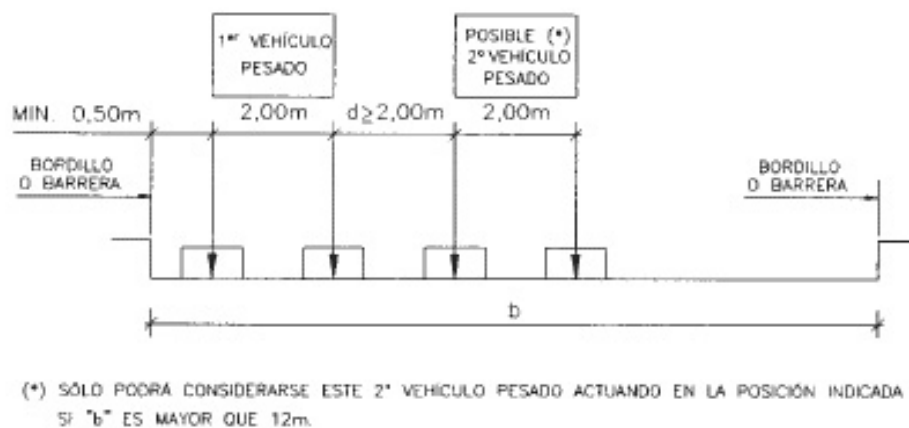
Alzado del tren de cargas de la Instrucción IAP-98
